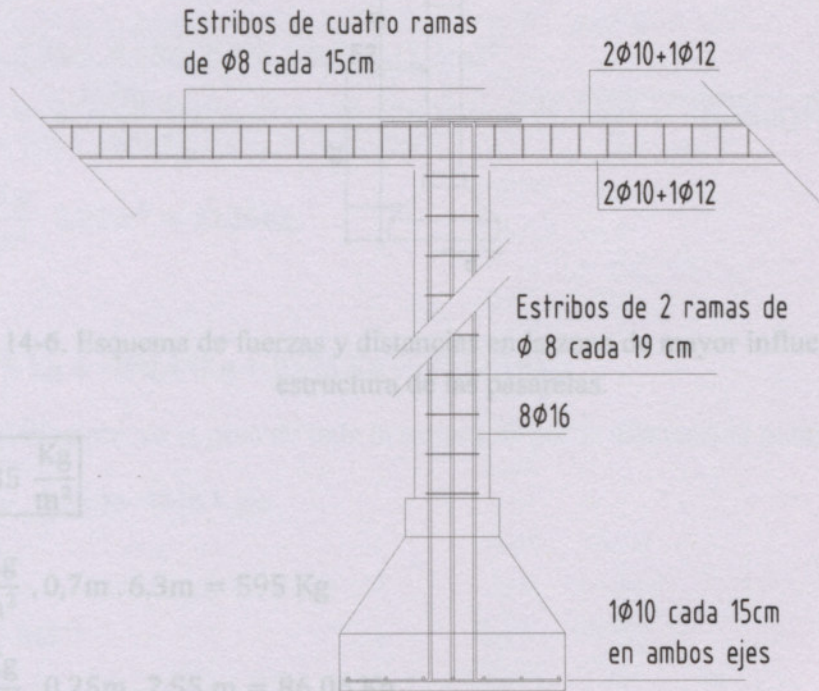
Esquema de fuerzas y distribución de armadura por influencia en la estructura.
